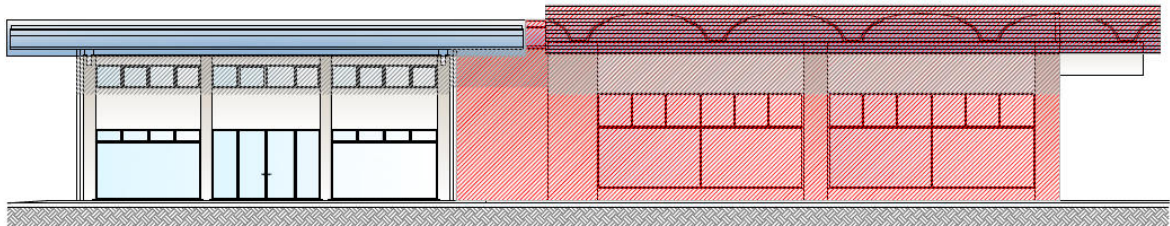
prospetto sud, in rosso la porzione in ampliamento
